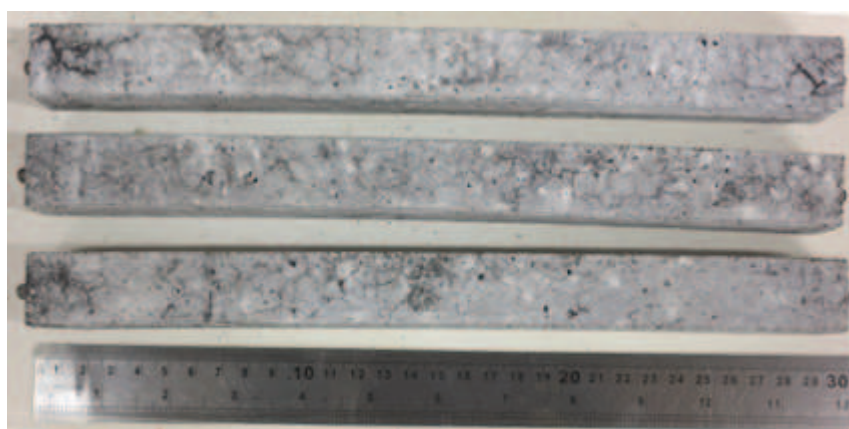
Aspecto das barras de argamassa REF após o ensaio acelerado
